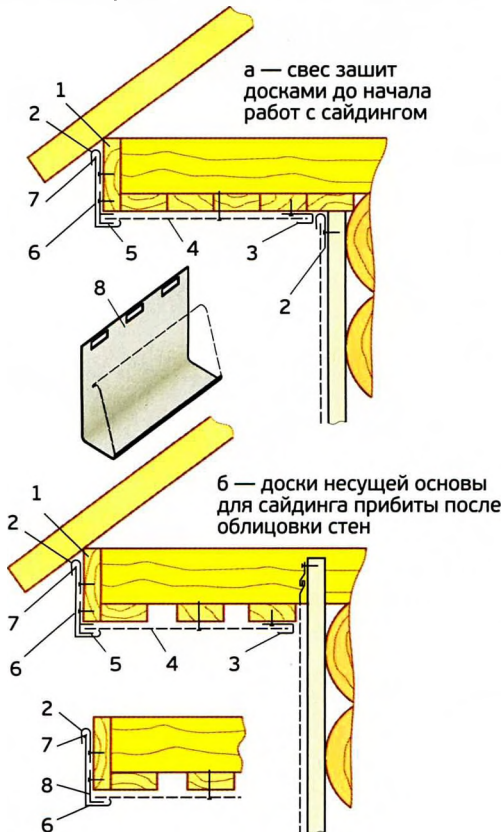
Облицовка карнизных свесов: 1 — лобовая карнизная доска; 2 — финишный профиль; 3 — пазовый (тип J) профиль; 4 — карнизные (софитные) заготовки; 5 — пазовый (тип F) профиль; 6 — карнизный профиль; 7 — «ушки»; 8 — держатель из наличника.
